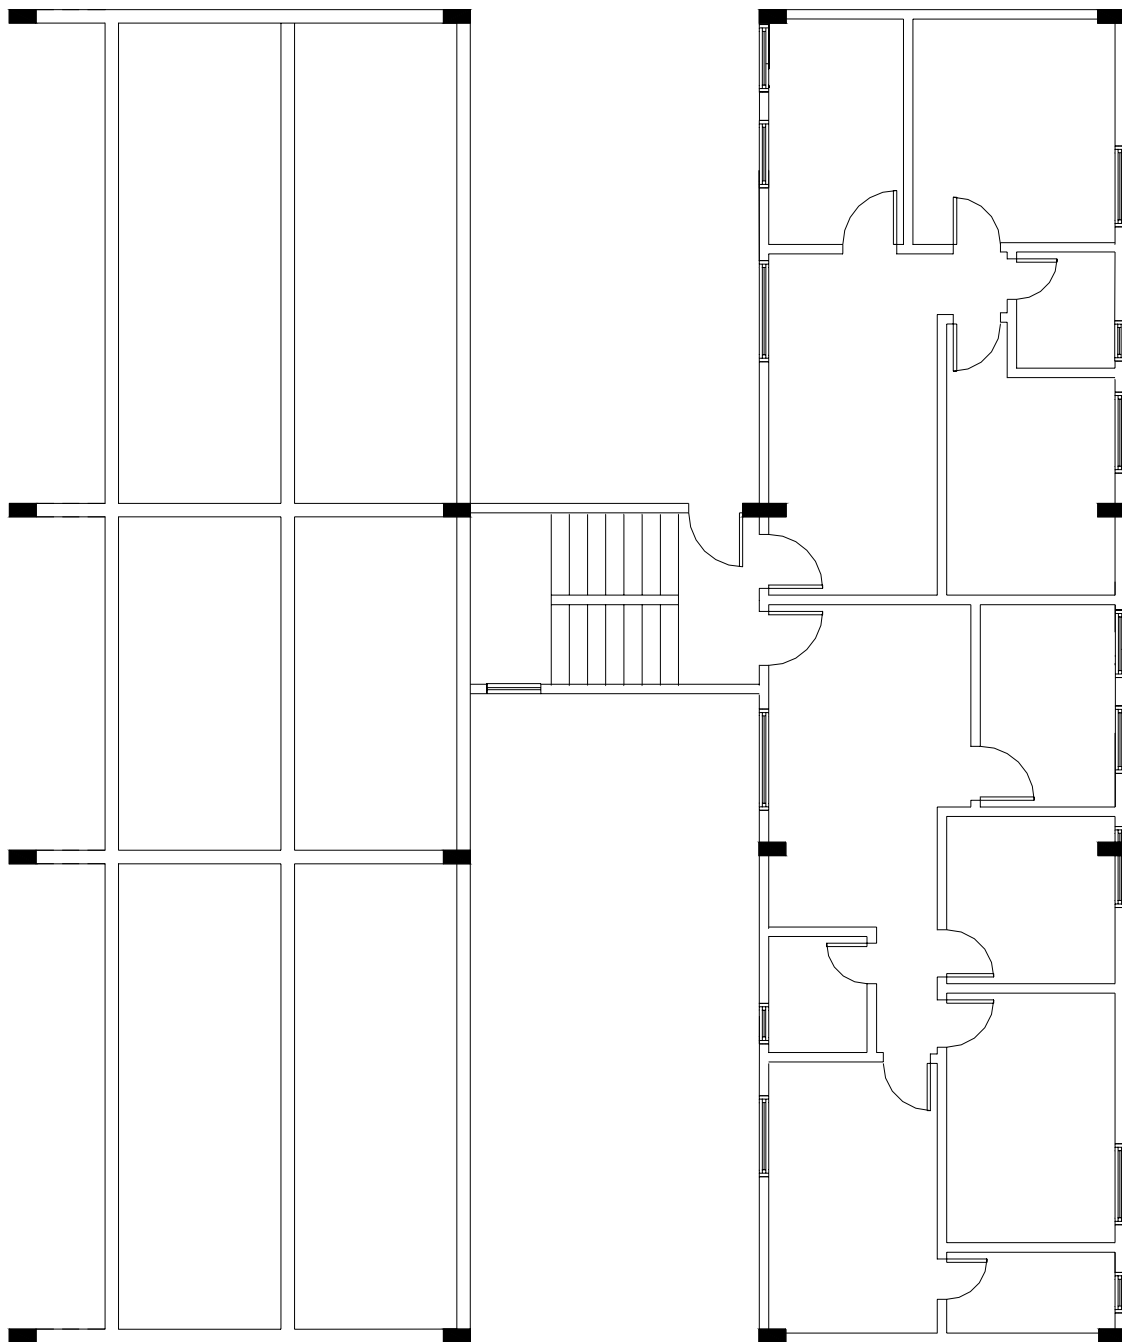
Residencial “J” – Bloco 5 – Primeira solução de vigamento de pilotis
